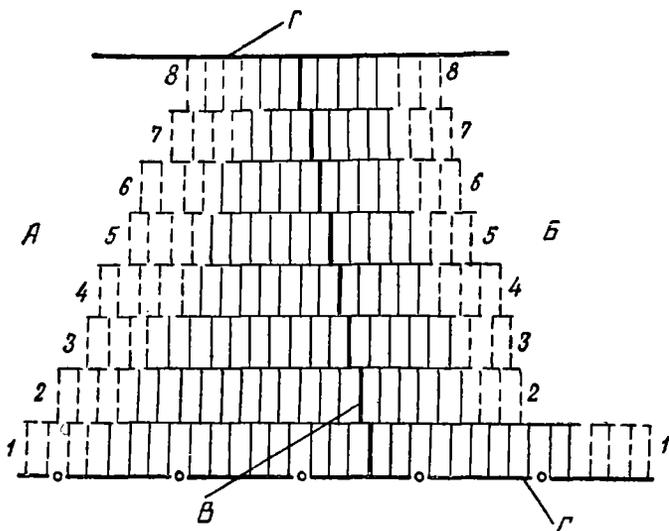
Схема укладки сборного покрытия из дощатых щитов:
